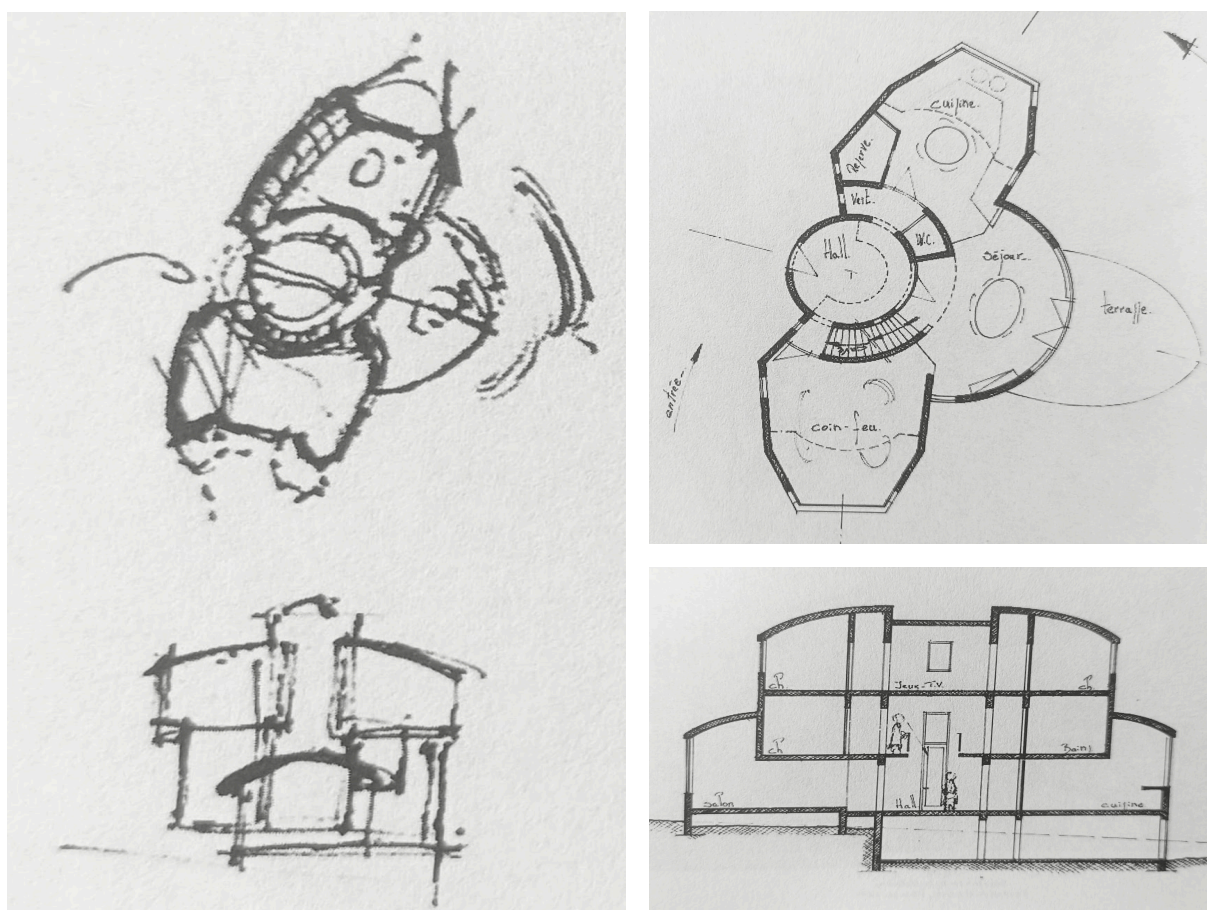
Croquis, plan et coupe *habitation Marchal*, 1994.
